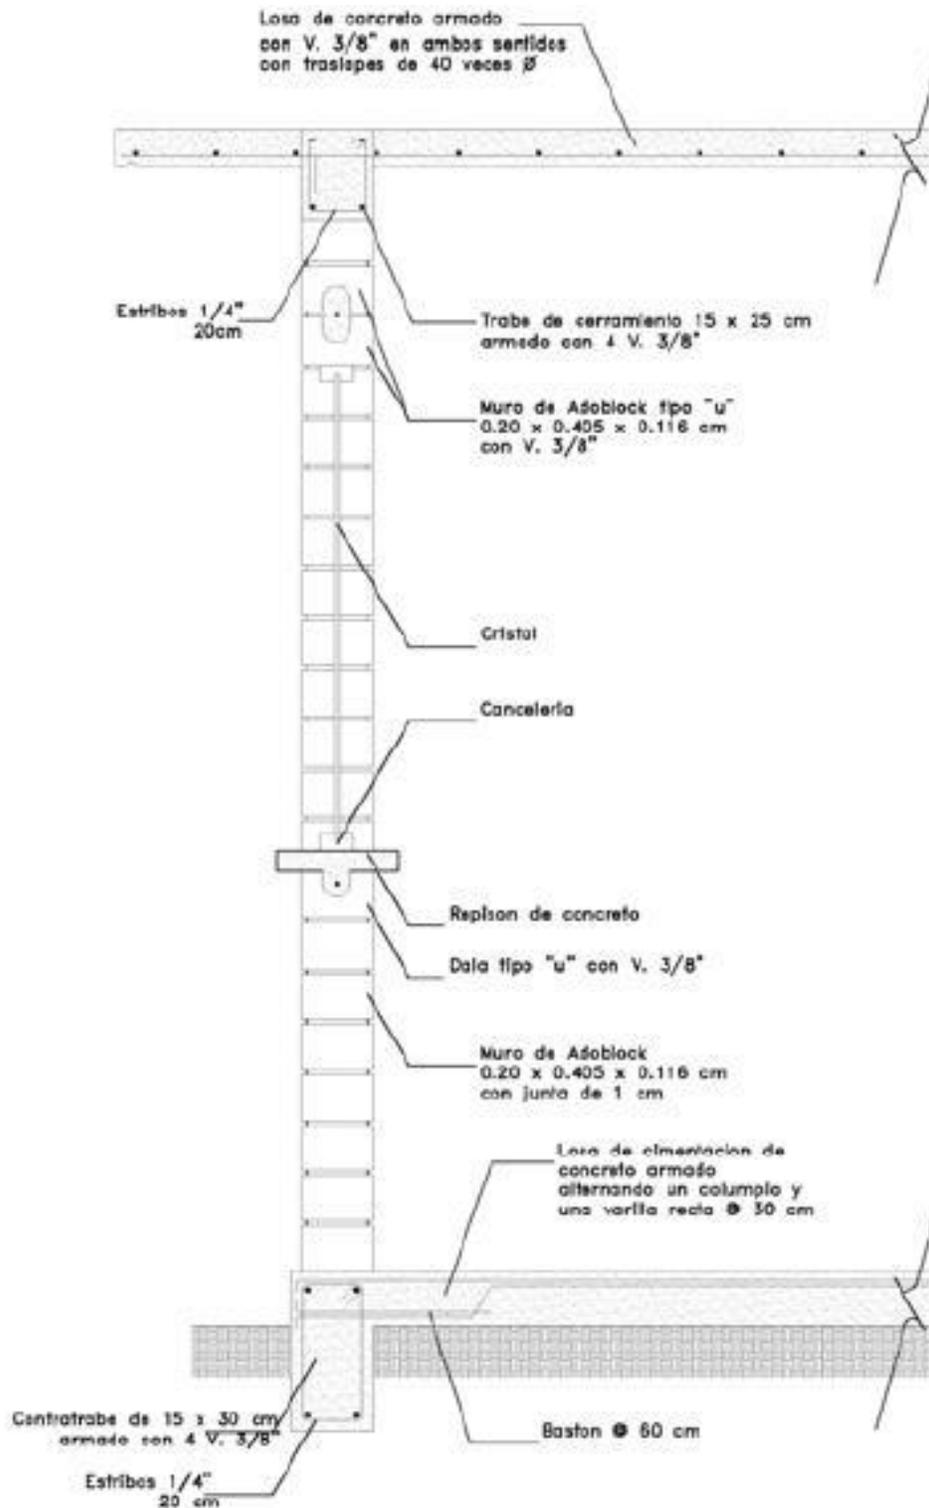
Corte por fachada de la vivienda sustentable donde se aprecia la losa de cimentación, contratrabe, muro, ventana, refuerzos horizontales, cerramiento y losa de concreto armado.
